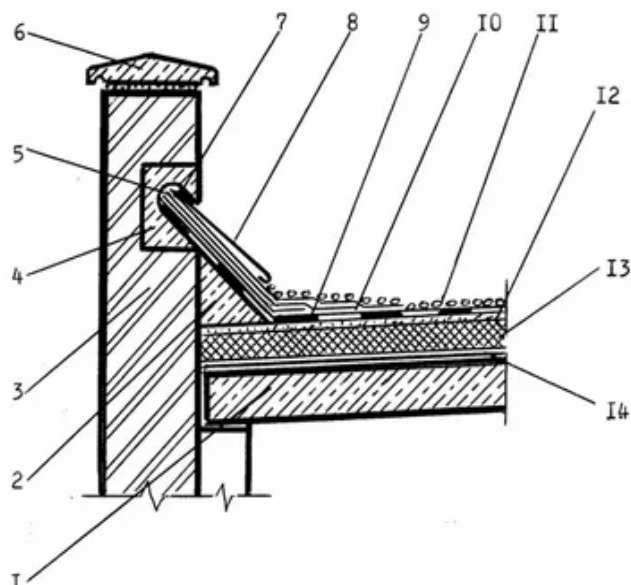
Детализовка элементов примыкания кровли к стене здания:
